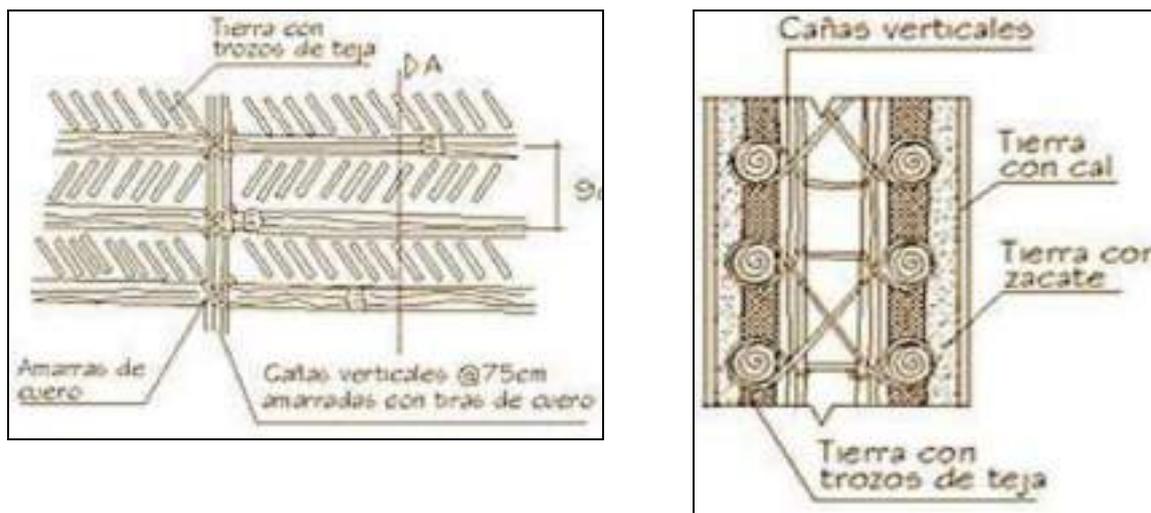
Detalle del muro de bahareque. (Fuente: Hernández, 2014)
